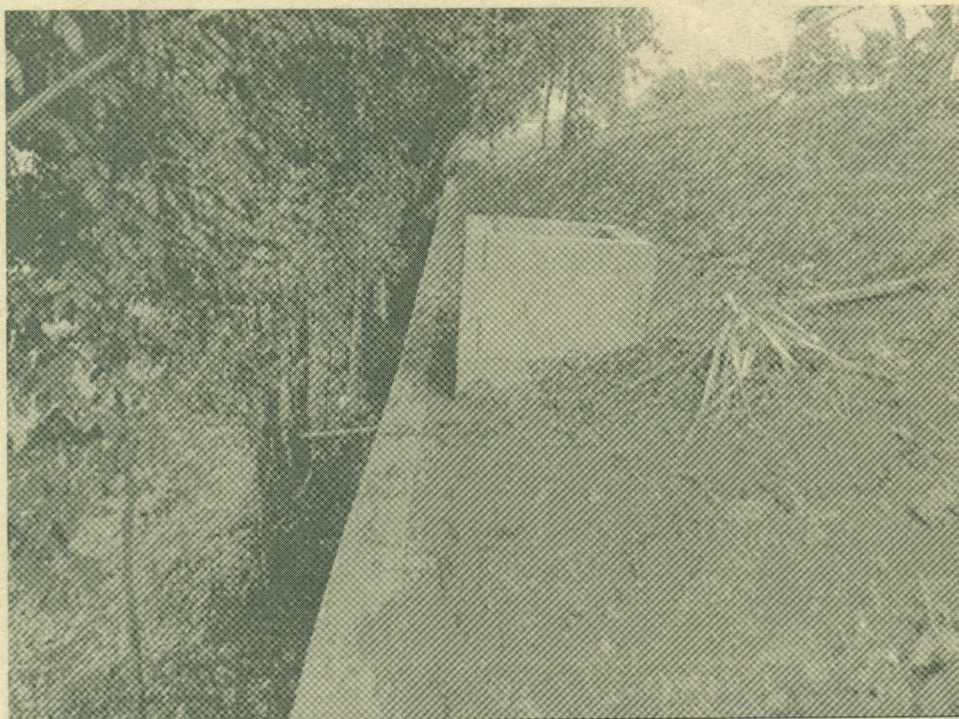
Se construyeron cajas de inspección a lo largo de la construcción del box, con el fin de realizar la limpieza.
